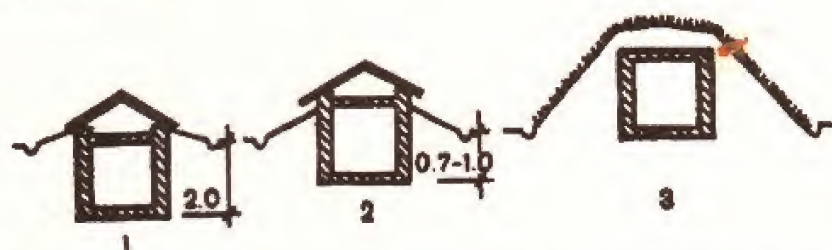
Схеми основних типів погребів: 1 - заглиблений; 2 - напівзаглиблений; 3 - наземний.
